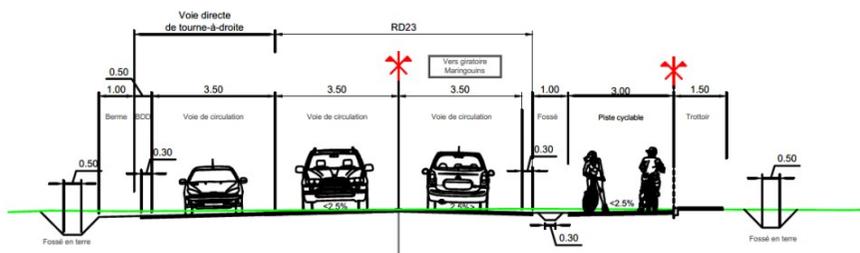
Principe de coupe en travers sur la RD23 sans la piste côté Ouest
